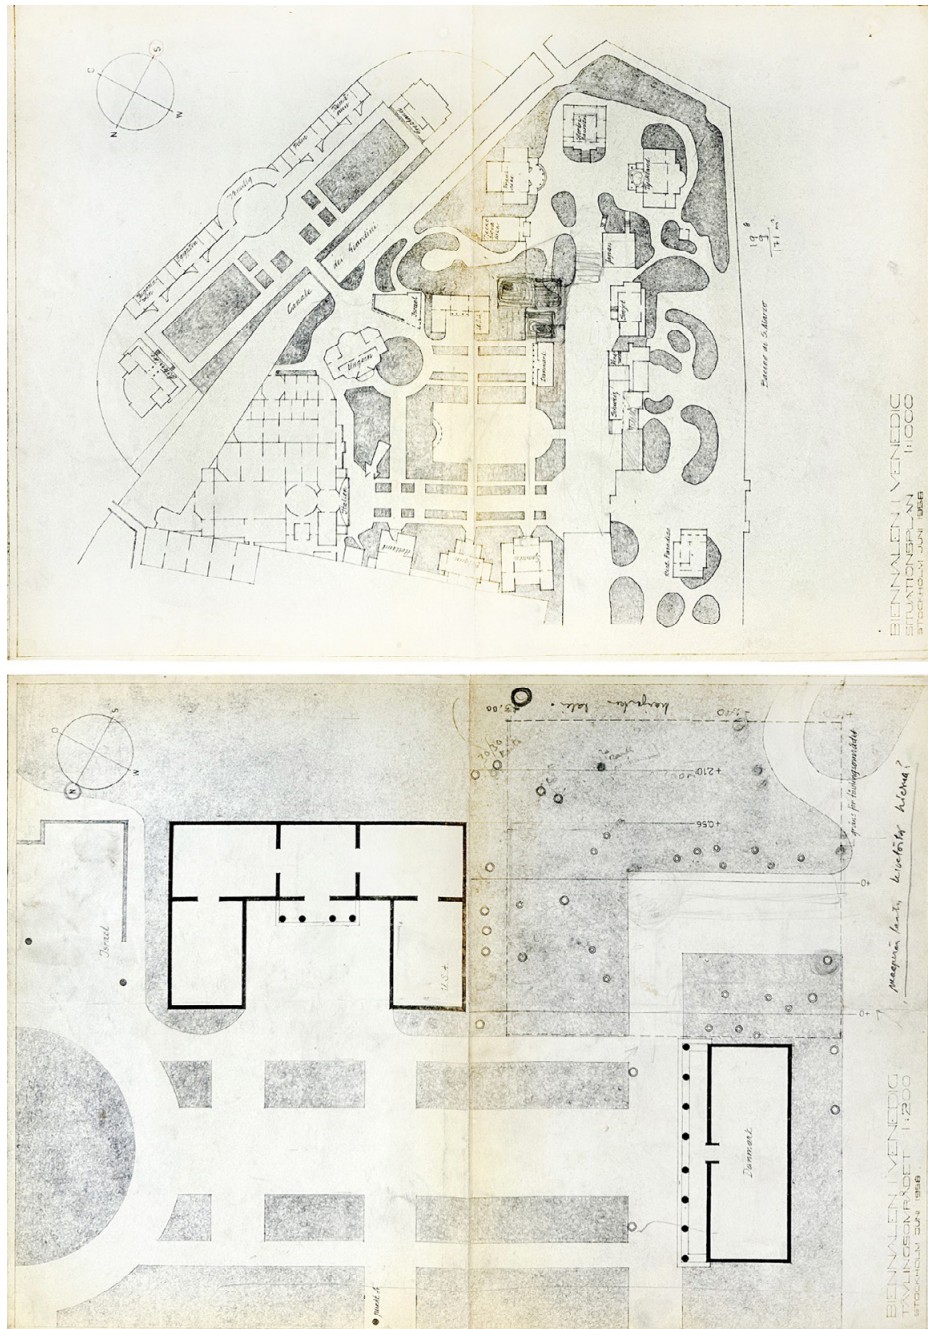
Arriba: Plano del recinto de la Bienal con un croquis de la propuesta 10 (02230) de Pietilä. Abajo: Plano del emplazamiento con anotaciones de Pietilä. 1958.
